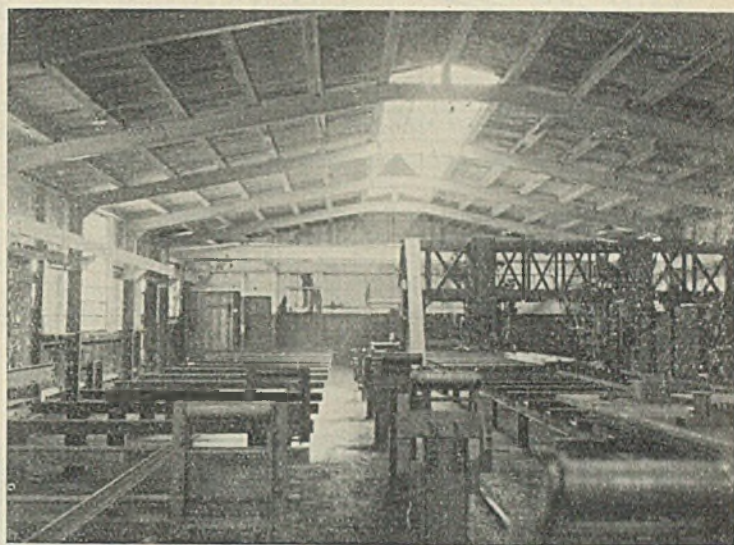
Werkstatthalle mit neuen geschweißten Rahmen.
